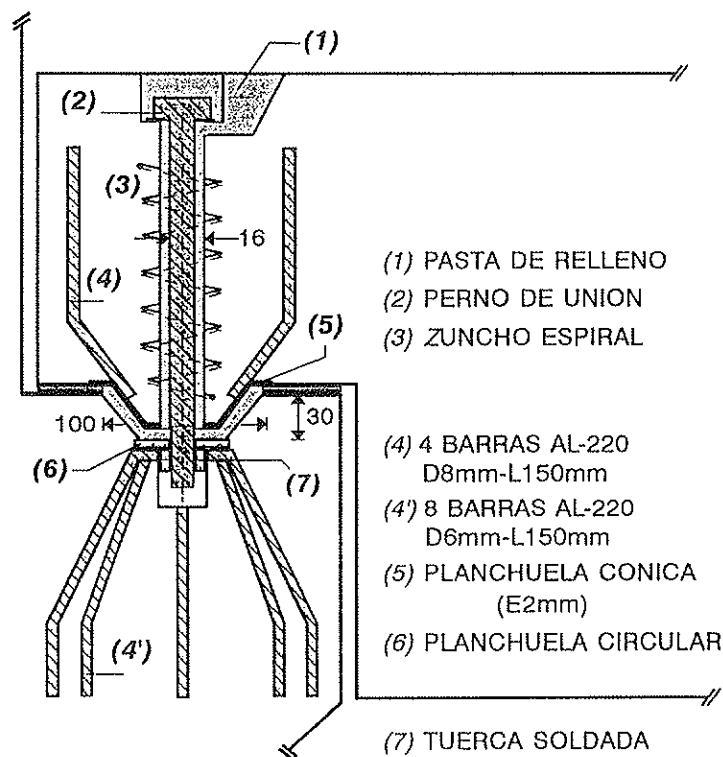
Detalle constructivo de la unión por encastre modificada (EMH).
